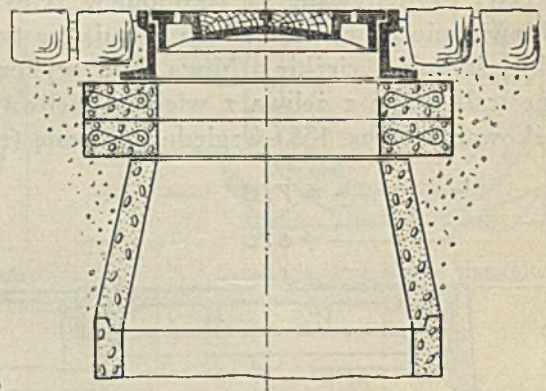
Pokrywa z wiekiem wypełnionym asfaltem.
